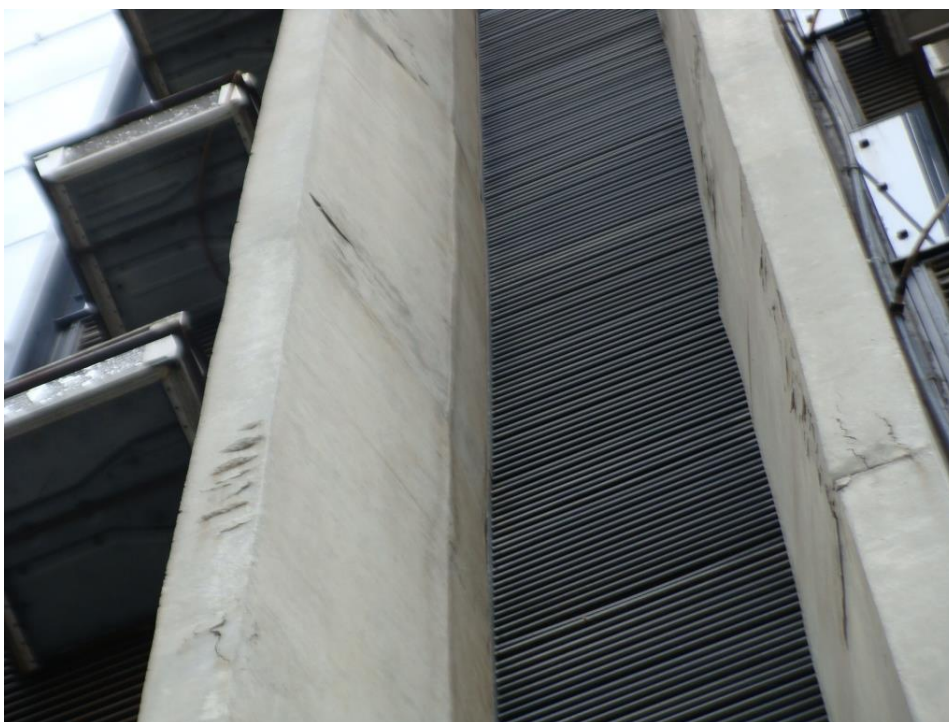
Armadura exposta pilar P13 (2º pavimento) (02/03/2021)
